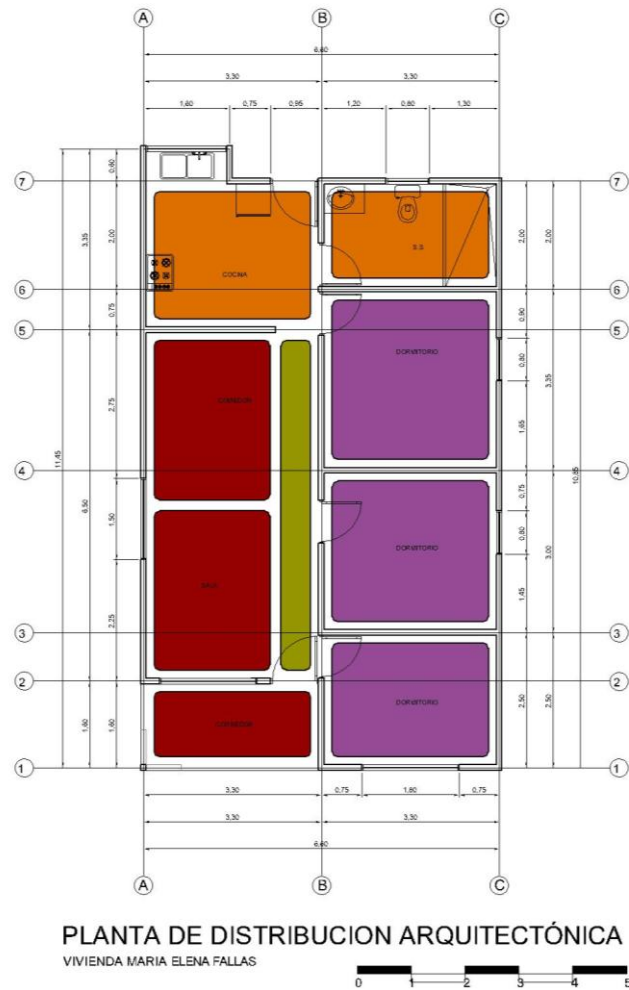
Vivienda María Elena Fallas. Planta Distribución Típica. Montes de Oca, San José. 2008. Fuente: Personal.
